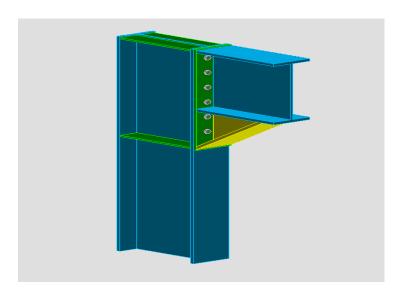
Assemblage poteau-poutre HEA700- HEA550
